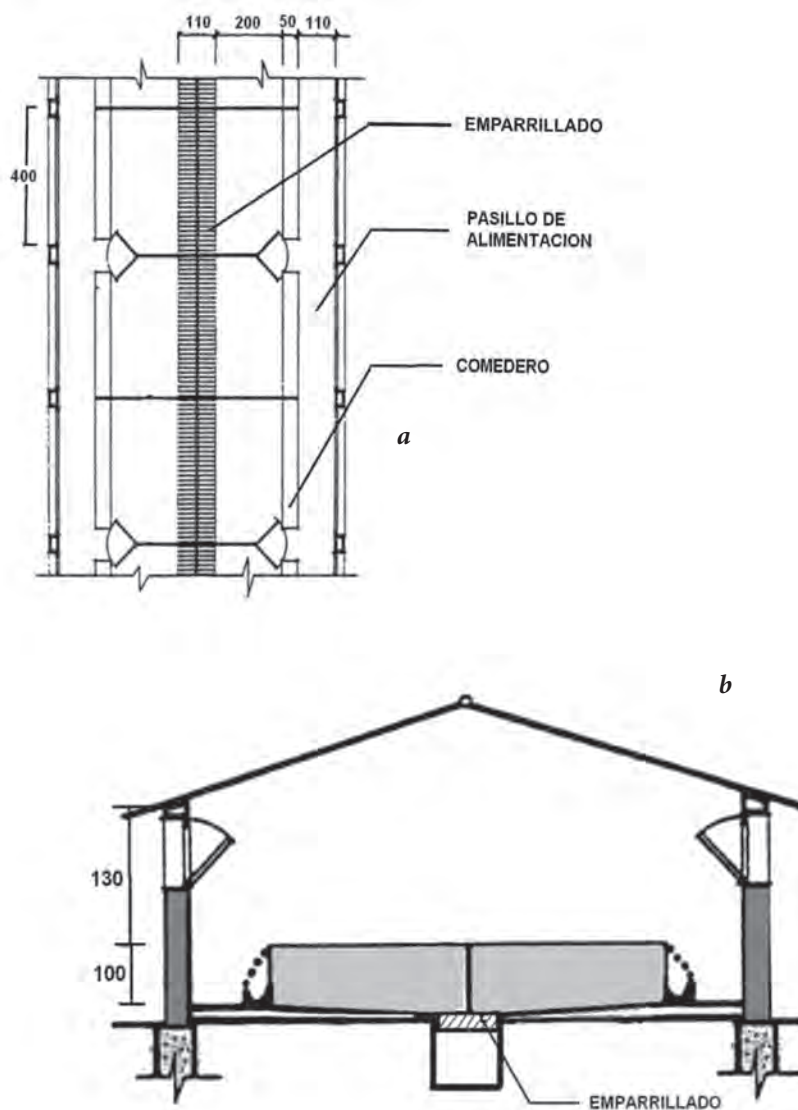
Piso de los cubículos parcialmente emparrillados, en una porqueriza para ceba (Medidas en cm). a) Planta. b) Corte.
